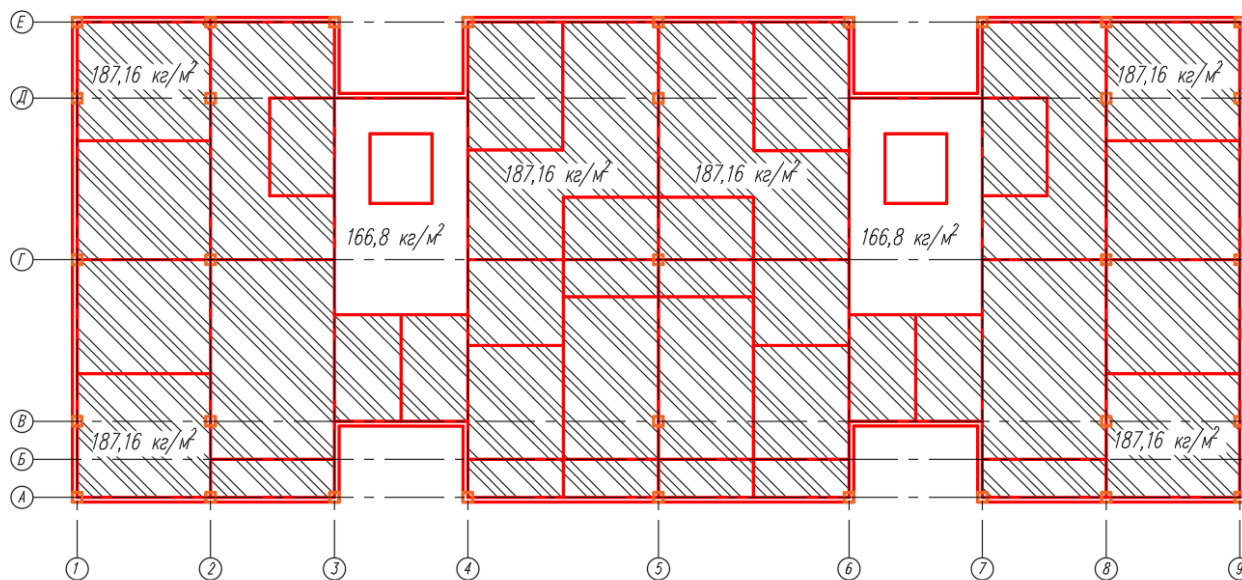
Схема приложения постоянных нагрузок на перекрытие от веса конструкций полов (2-5 эт), кг/м²
